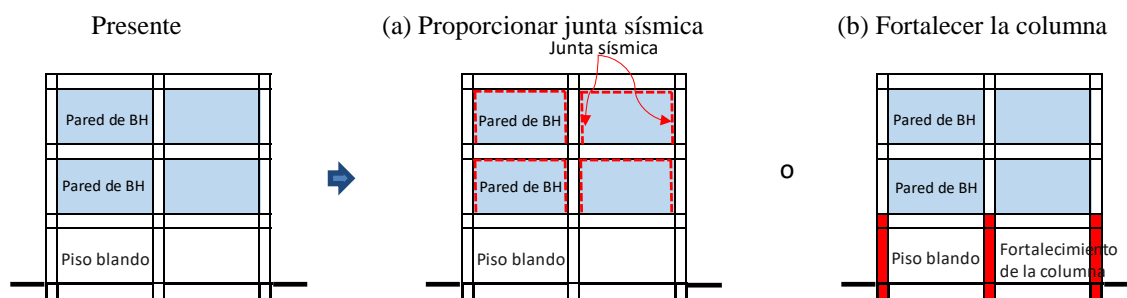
Contramedidas recomendadas para la pared no estructural (Fuente: JET)
